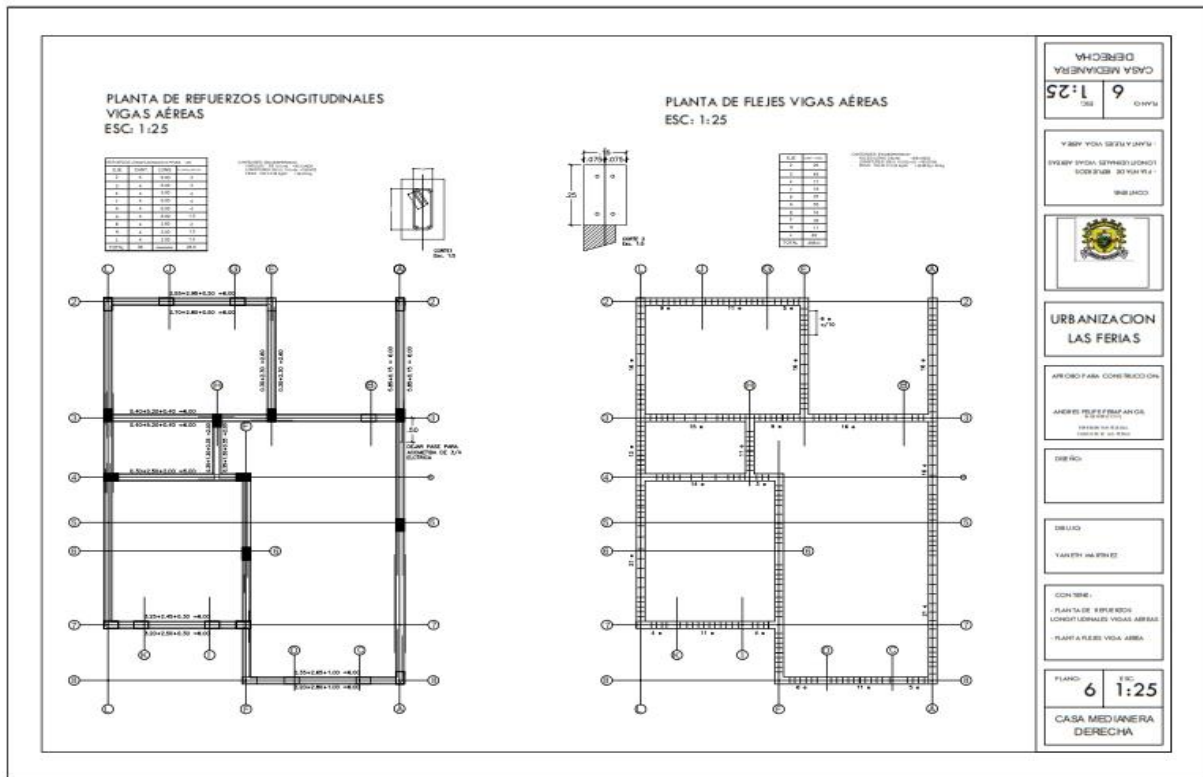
Planta de refuerzo longitudinales vigas aéreas.
